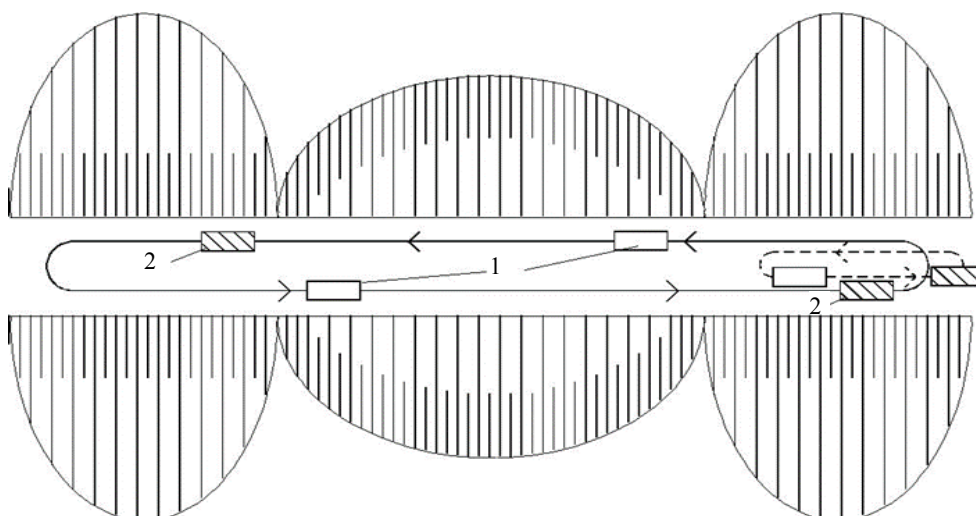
Еліптична схема руху скреперів із виїмки в два насипи: 1 – набирання ґрунту; 2 – розвантаження ґрунту
